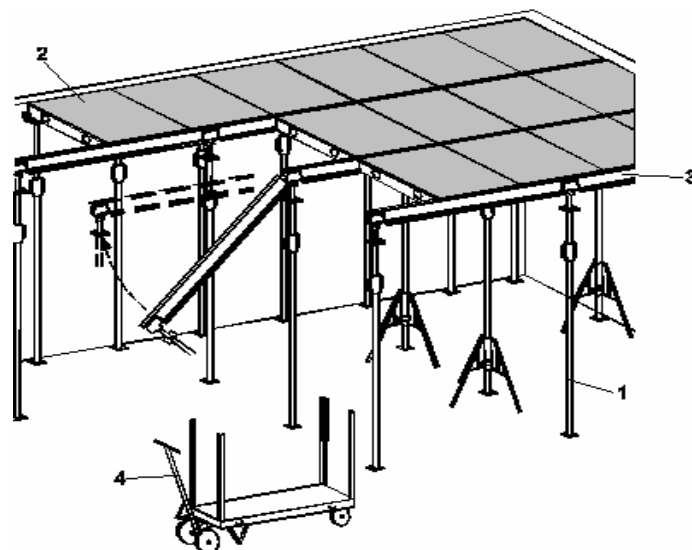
Схема опалубки перекрытий на основе телескопических стоек с падающими головками: 1 — телескопическая стойка с падающей головкой; 2 — щит опалубки перекрытий; 3 — продольная балка; 4 — тележка для транспортирования щитов опалубки перекрытий [27]
